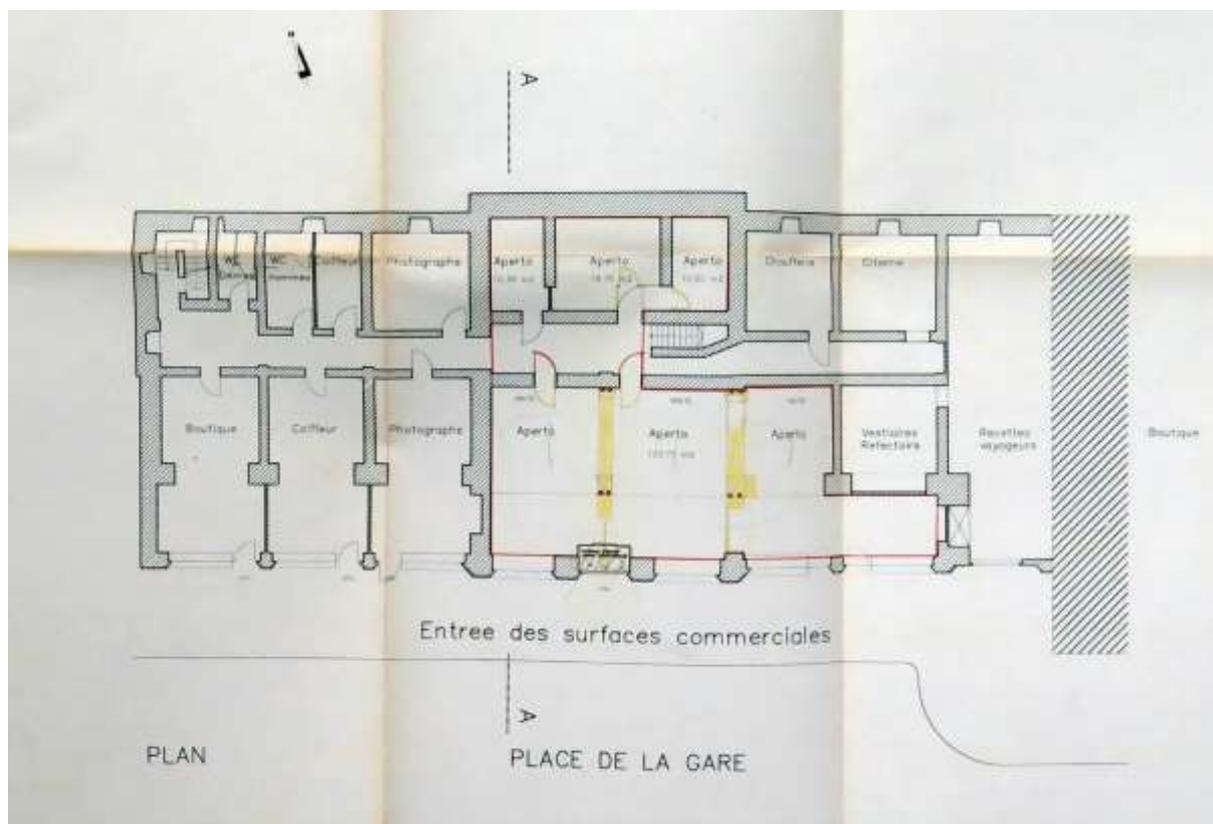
Projet de création d'un magasin Aperto, plan, Division des travaux I Section des bâtiments, 10.8.1992 (CFF Lausanne Immobilier, SBB-IM-WEST 18000/101/42653/2018.01/1/1).
